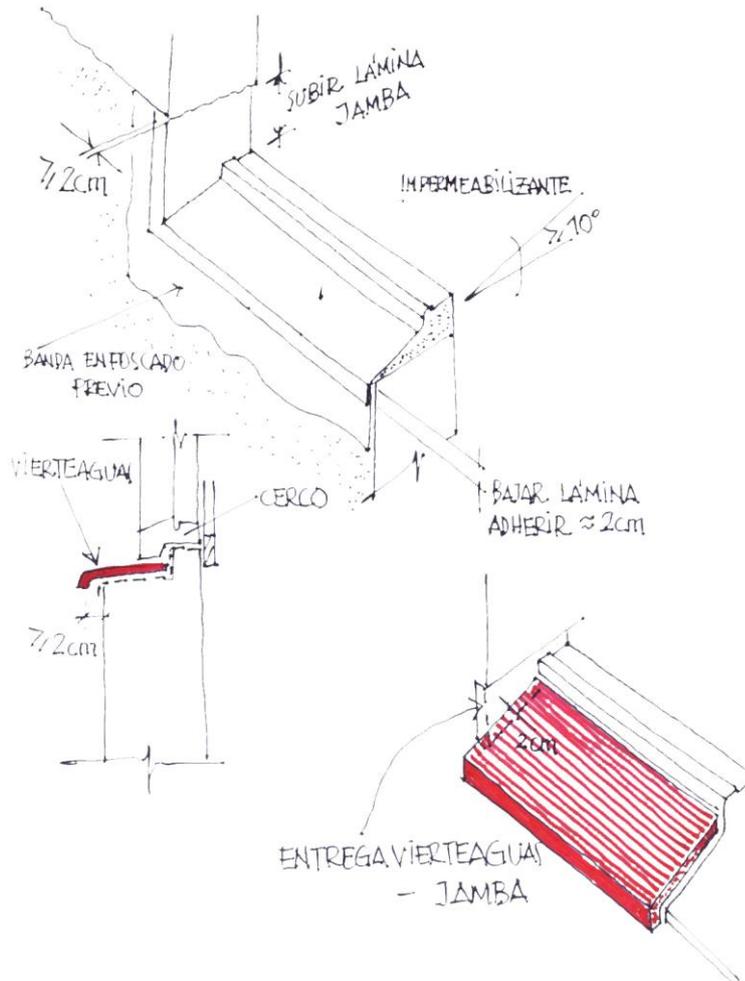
Esquema de encuentro fachada – carpintería
